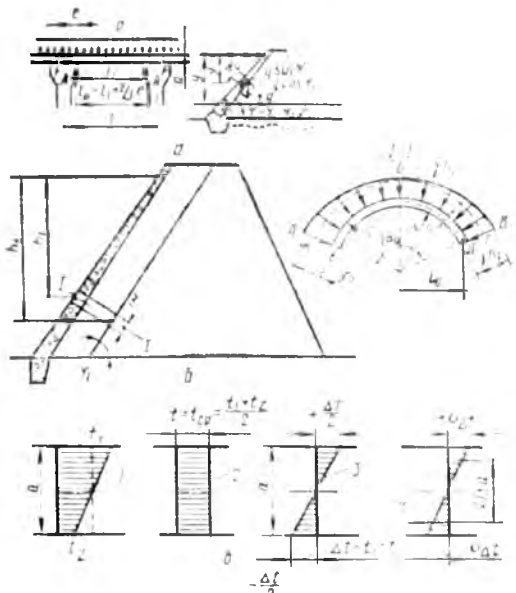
Схемы к элементарным расчетам напорных перекрытий:
